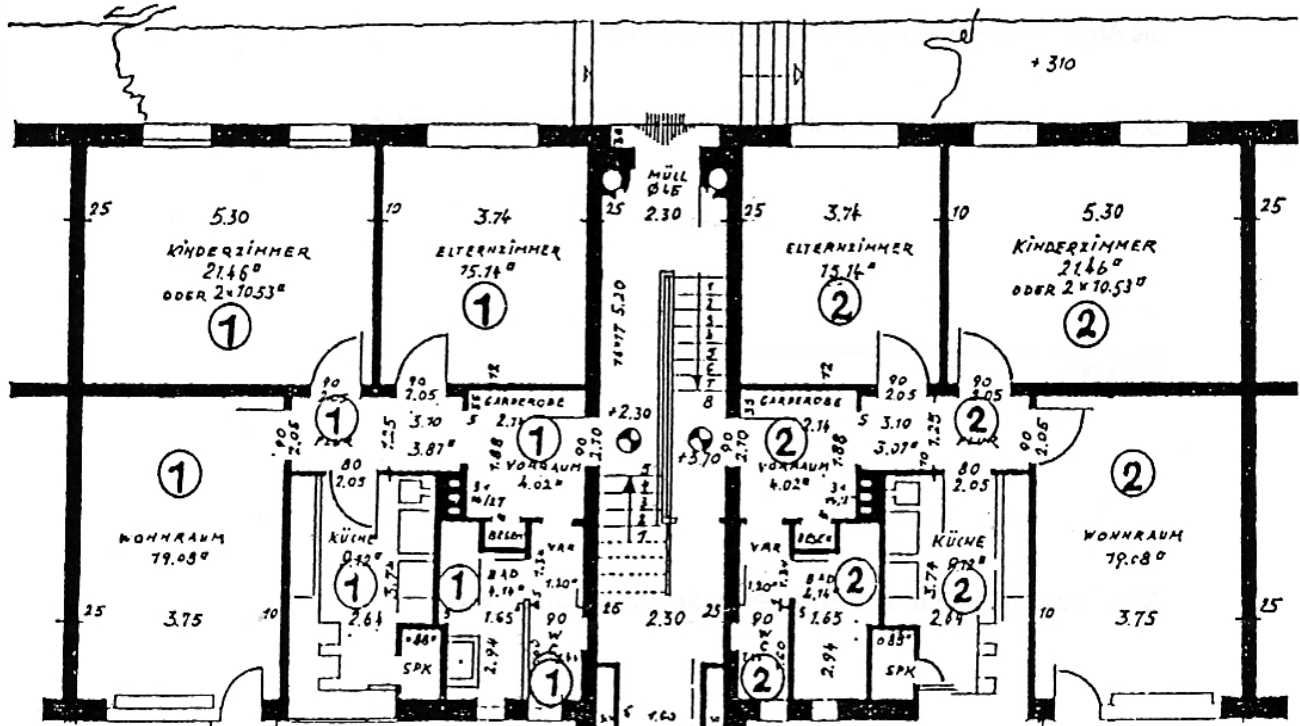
Beispieltfahter Grundriss (Erdgeschoss)
